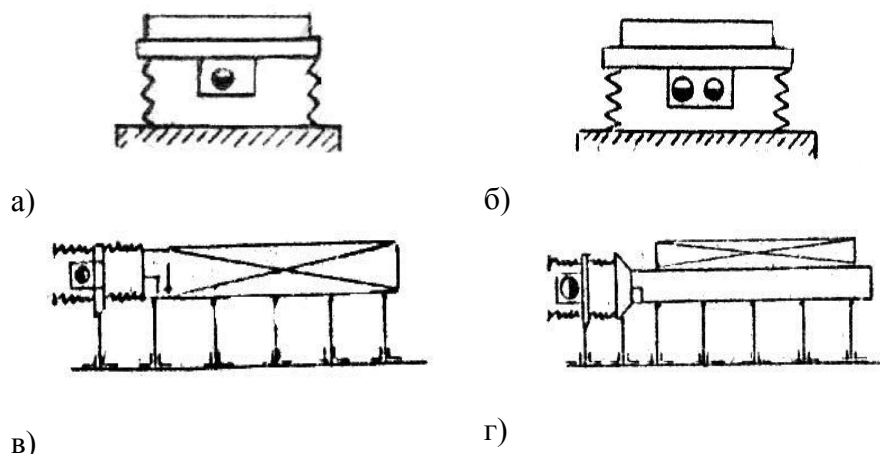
Виброплощадки: а) с круговыми гармоническими колебаниями;
